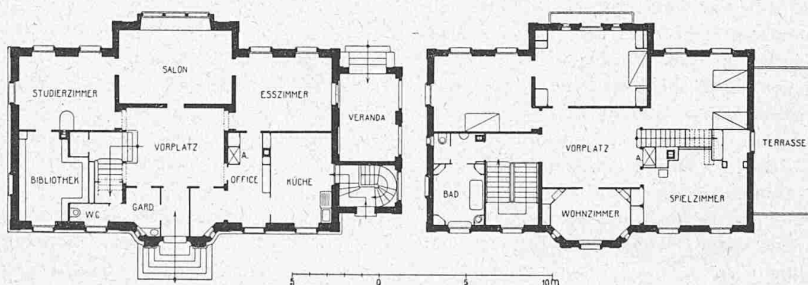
und 2. Grundrisse 1:400. — Abb. 3 (unten). Lageplan 1:800.
